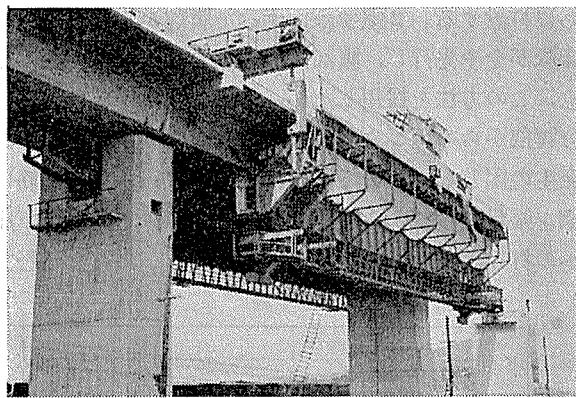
ストラバーグ移動中（前後の台車に支えられ、まず支保工桁が移動、プラケットはこのとき同時に移動する）
